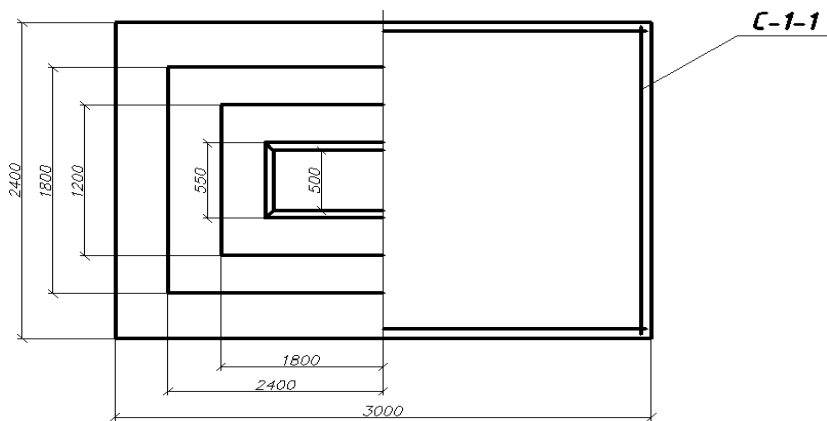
Ступенчатый фундамент: б) монолитный трехступенчатый фундамент
